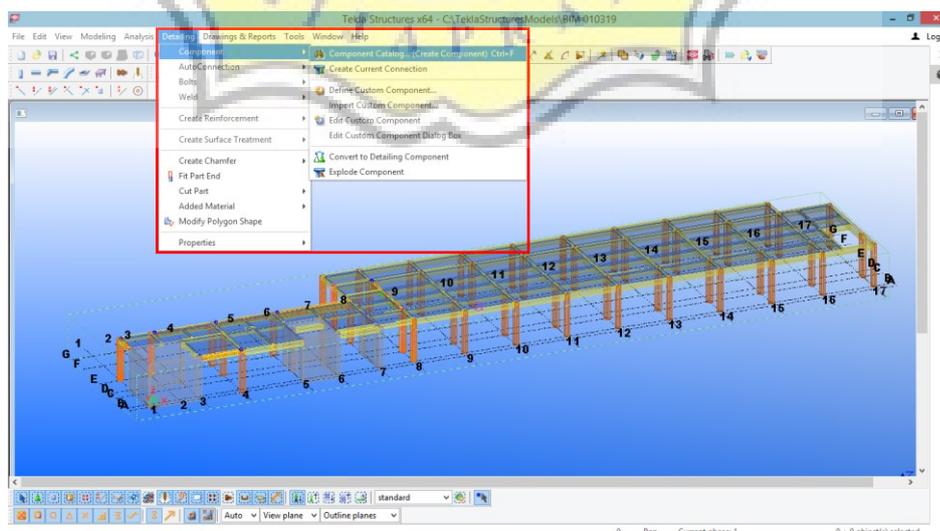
Pemodelan Struktur Kolom Gedung RS Panti Wilasa
